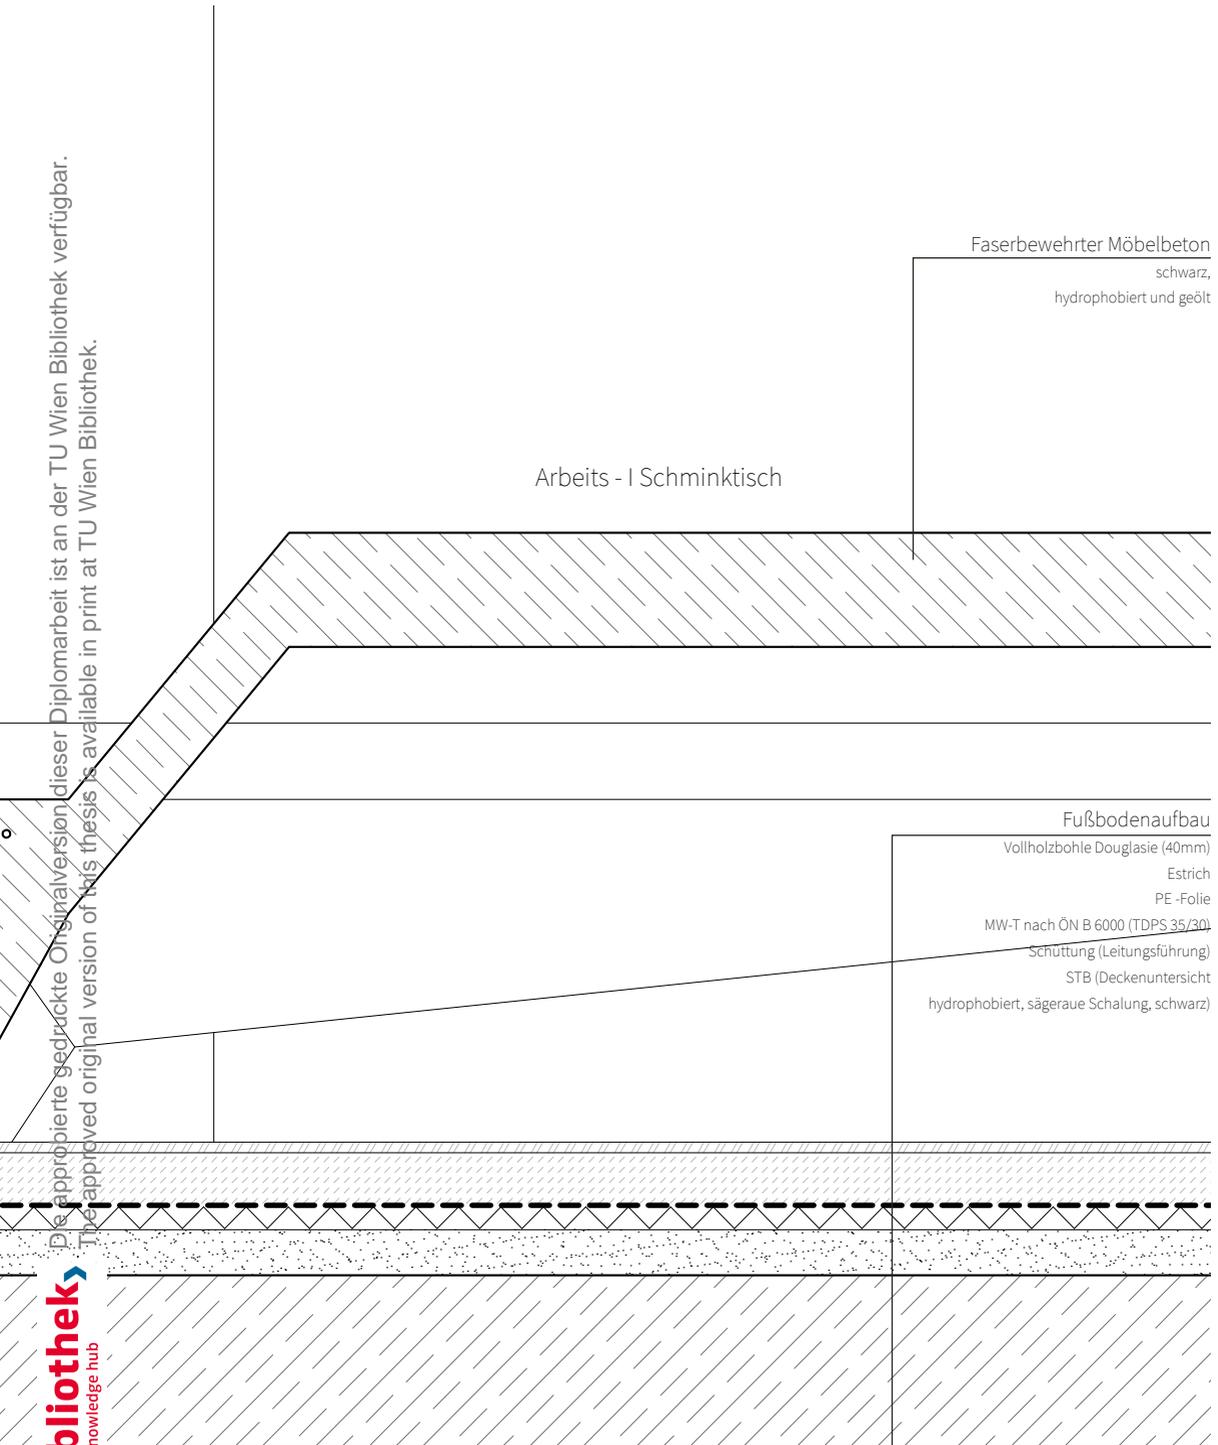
| Möblierung Hotelzimmer Junior - Suite Detailschnitt 1 | Sitznische und Schreibtisch aus Möbelbeton
